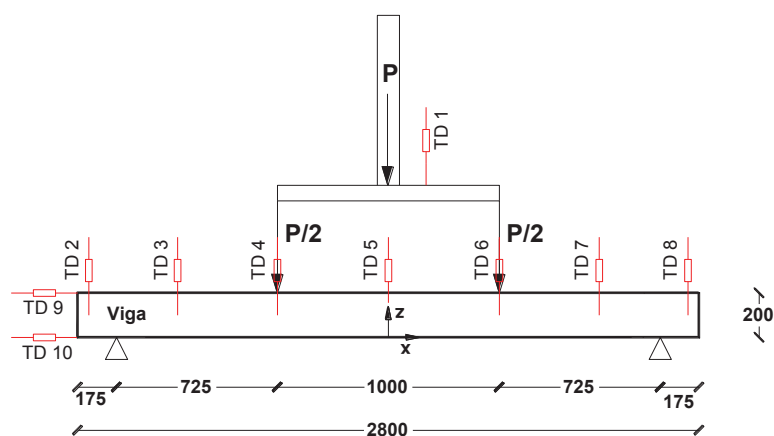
disposición de transductores en los ensayo de vigas a flexión.
